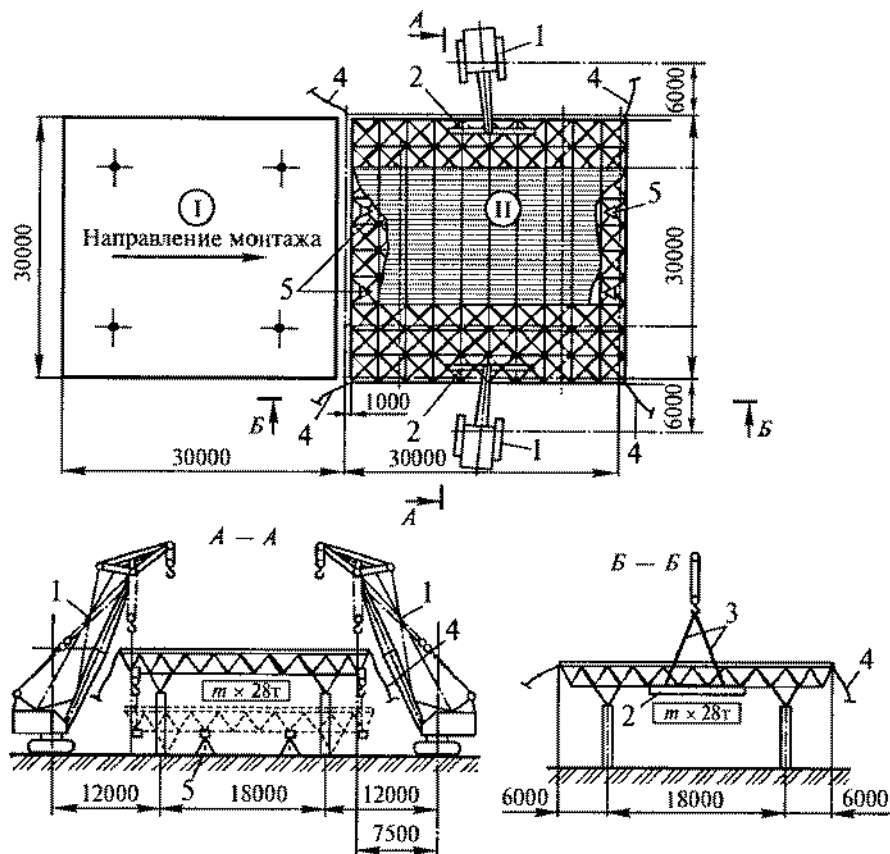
Монтаж блока покрытия двумя кранами:
